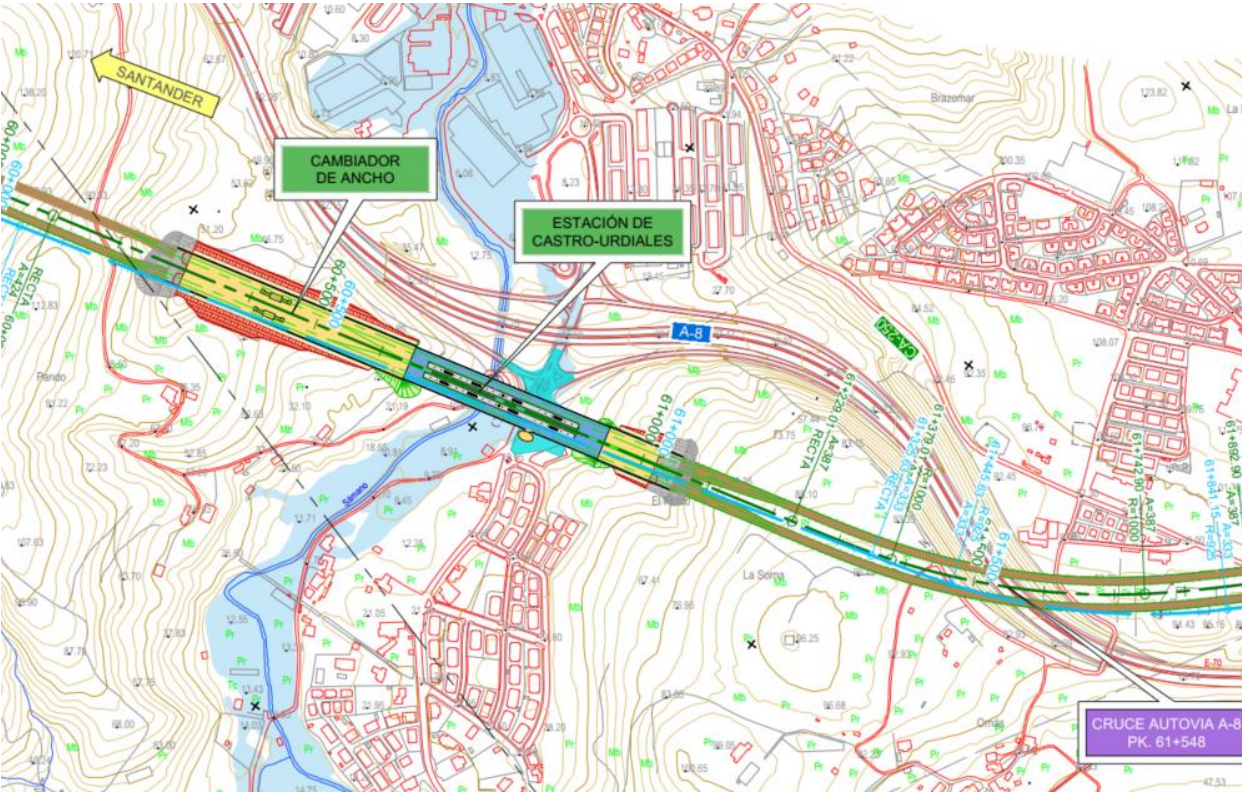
Planta Alternativa C1 rasante baja (color verde) frente rasante alta (color azul)
